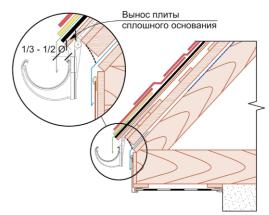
Укладка сплошного основания из плит ОСП-3 или фанеры ФСФ по обрешётке.
